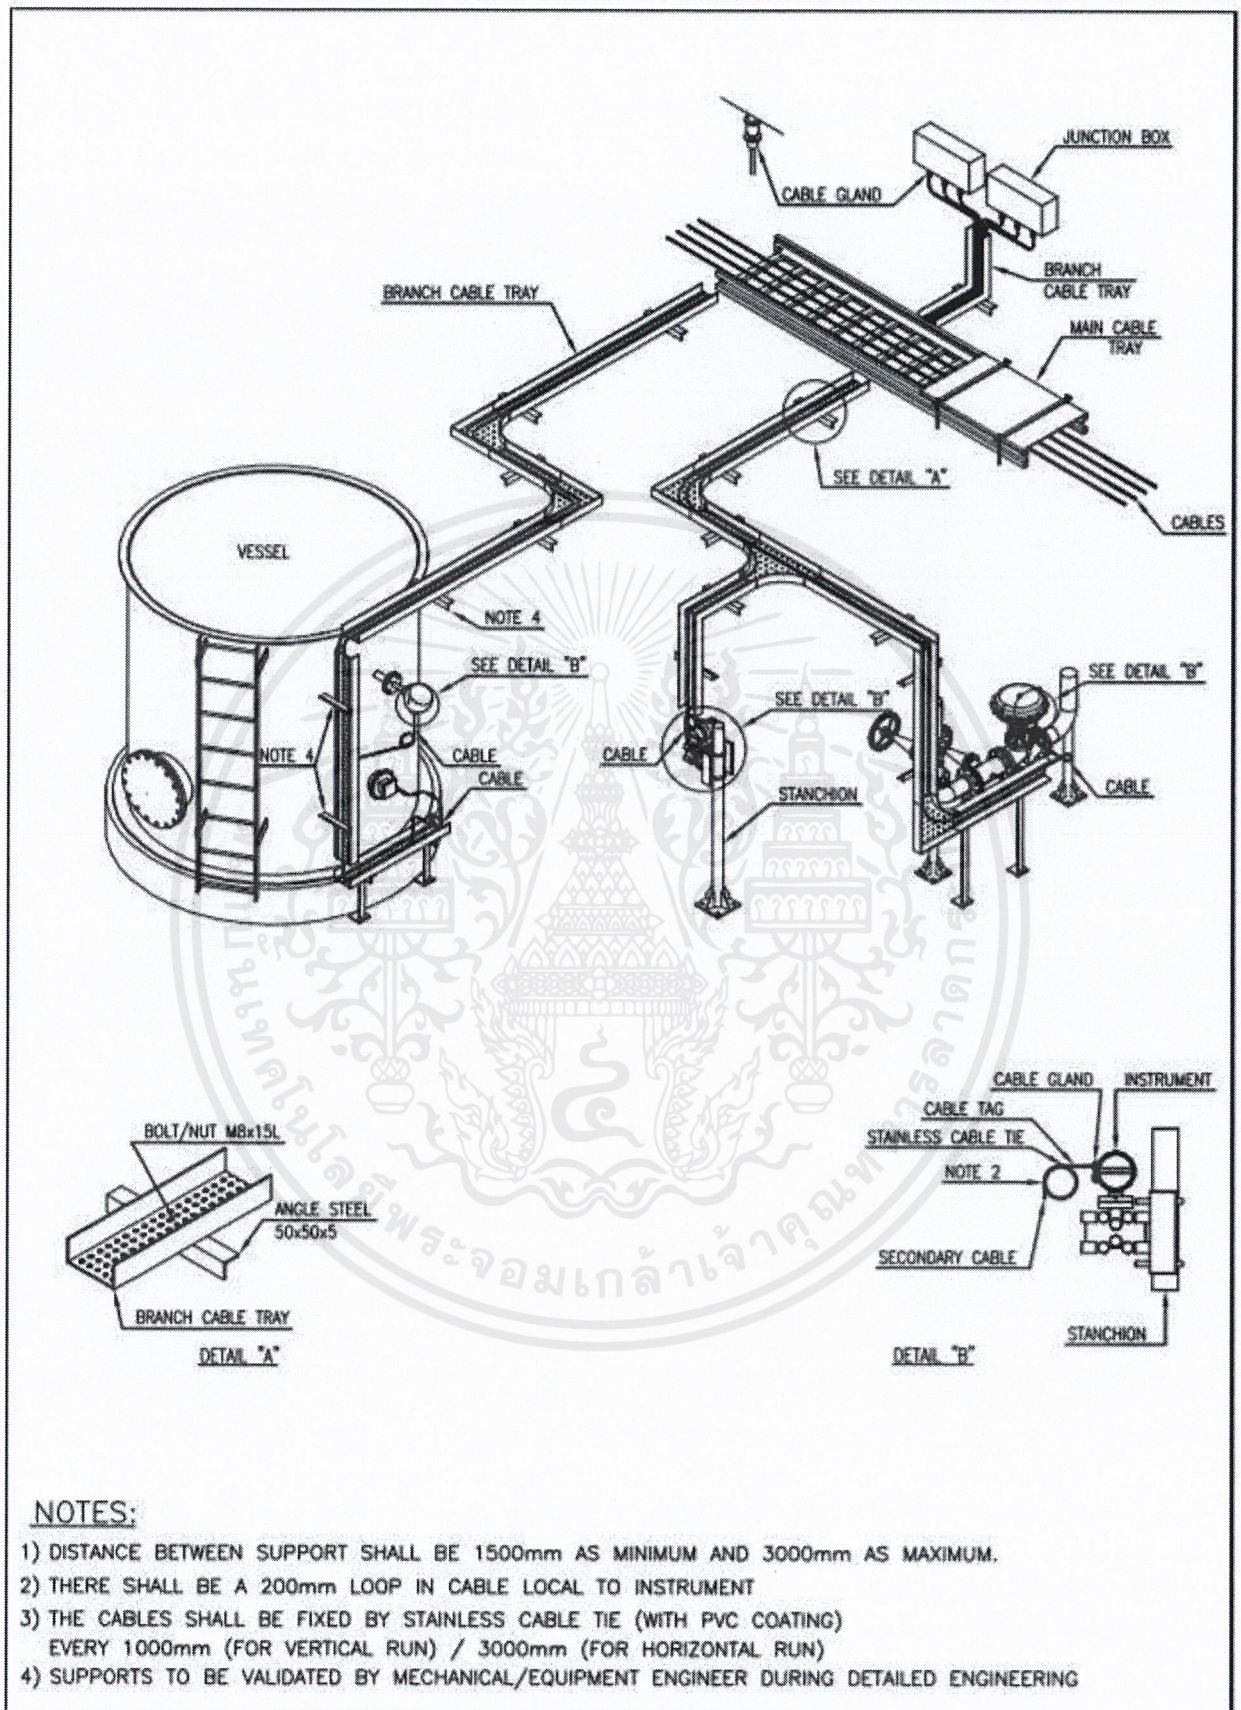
แสดงตัวอย่าง Installation Detail (ต่อ)
